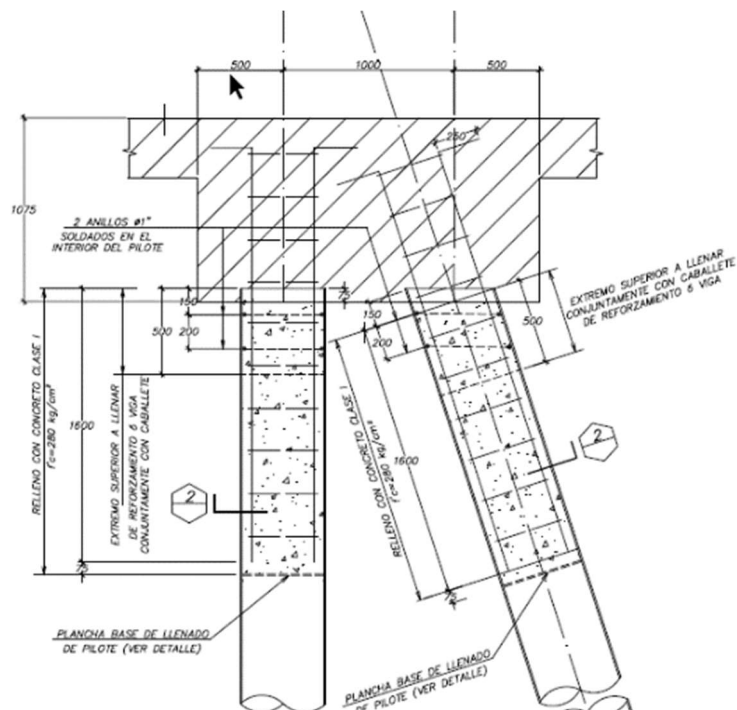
Conexión del plug del pilote de acero con la plataforma
